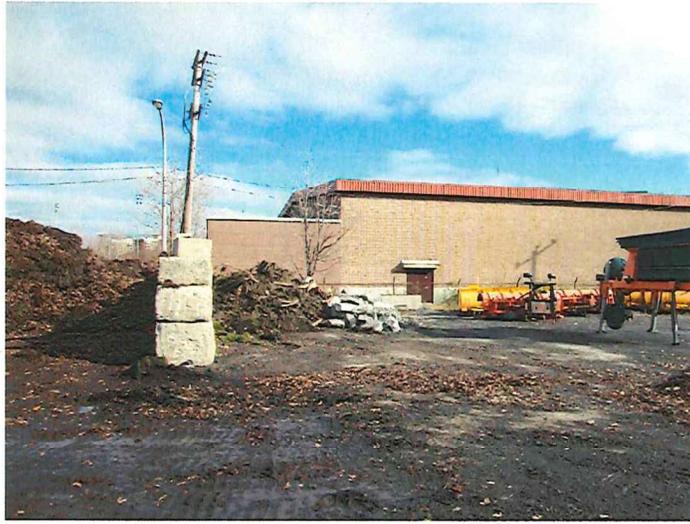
(DSCN0001.JPG) : Entreposage de terre et béton.
